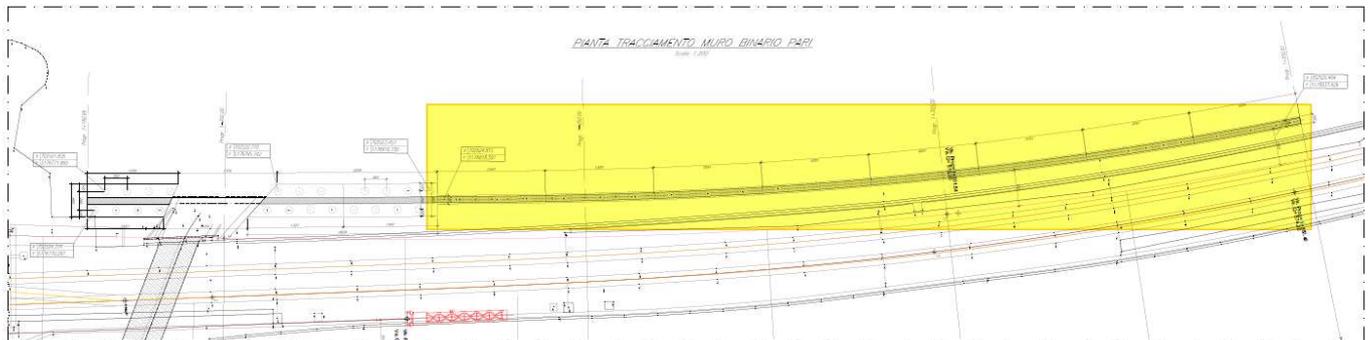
Individuazione Muro in c.a. su fondazioni profonde BP – Planimetria
